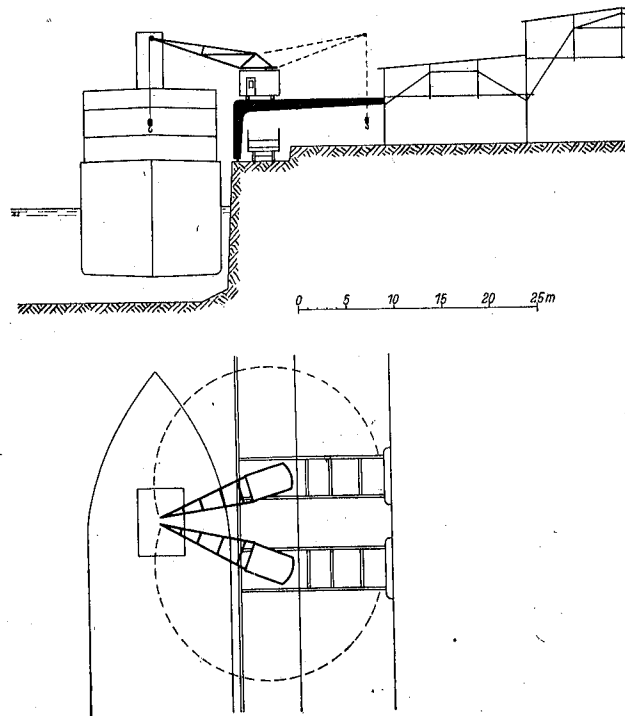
Stückgutkai mit Halbportalkränen mit starrem Ausleger um 1920. Querschnitt und Grundriß
